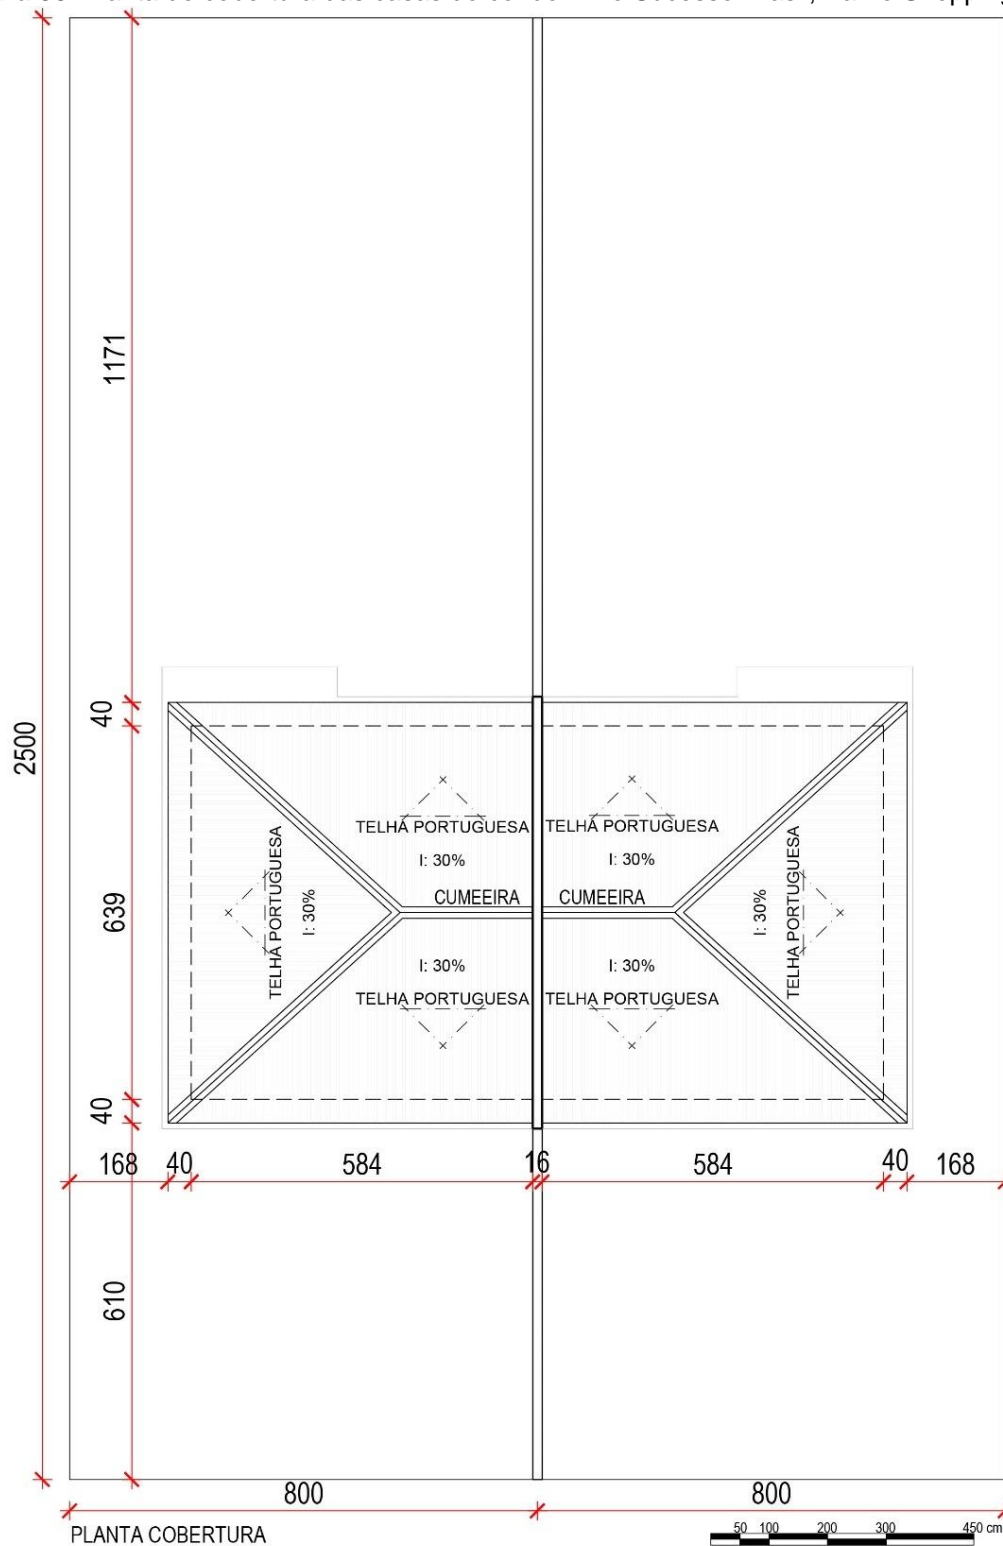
Planta das casas do condomínio Sucesso Brasil, Bairro Shopping Park
